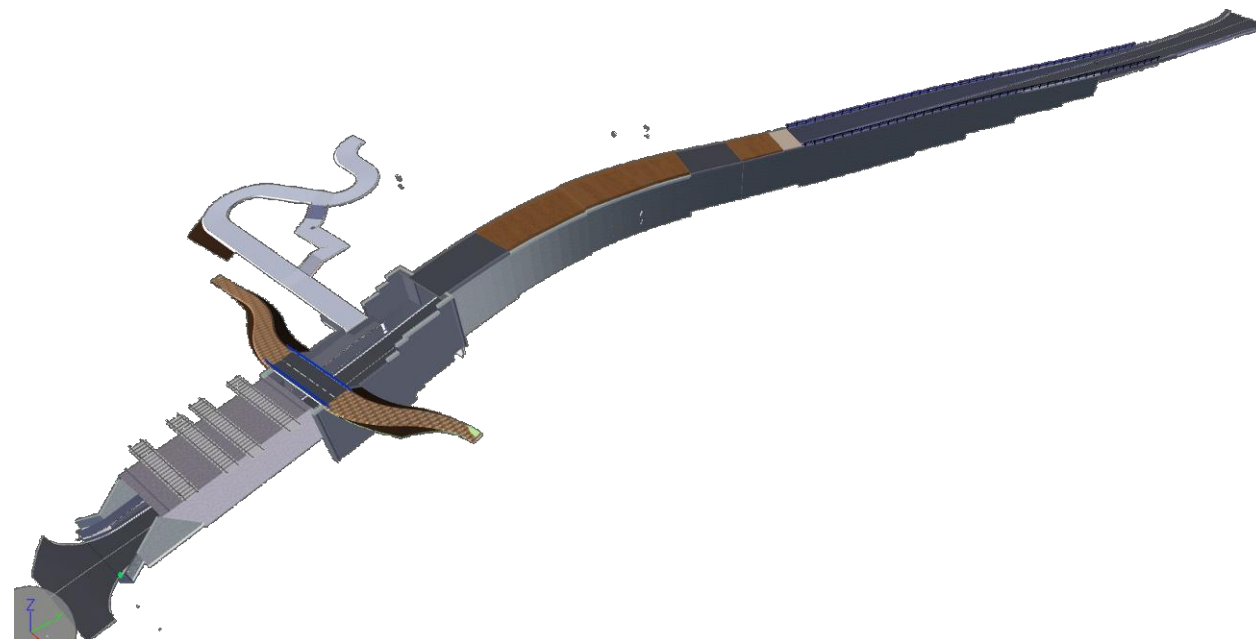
Vista general de la solución desde el sureste. Vista de elementos constructivos.
